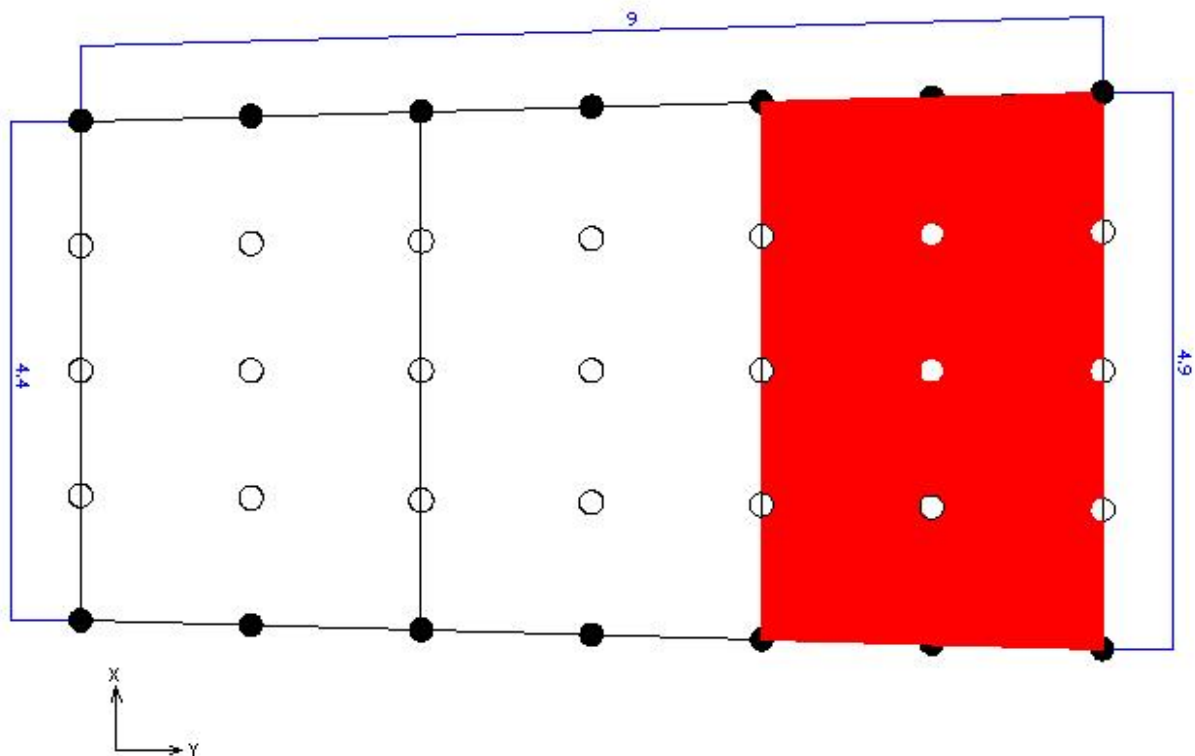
52 Divisione del pavimento della struttura in pannelli
